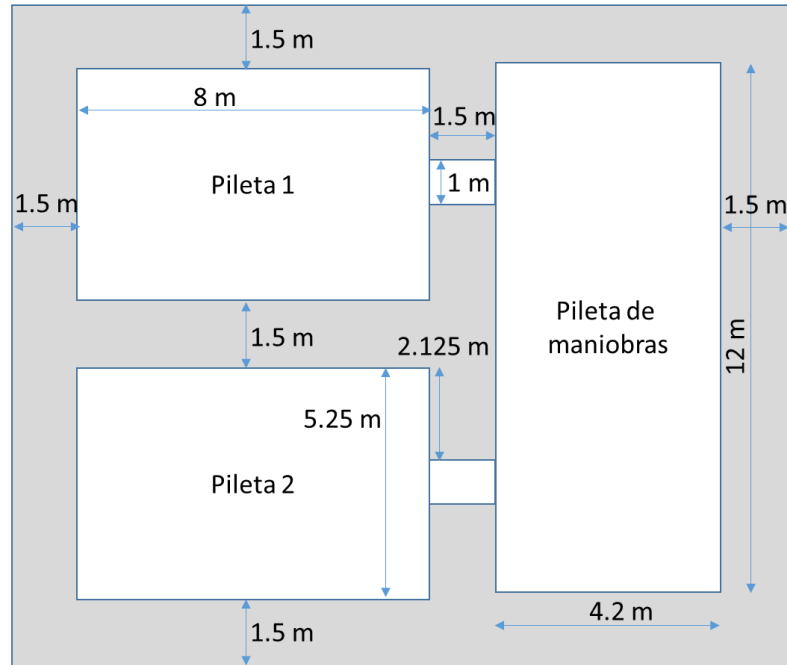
Esquema de las dimensiones de las piletas de la Casa de Piletas 1 (vista de arriba, plano X-Y). Dimensiones extraídas del plano "M13-29"
